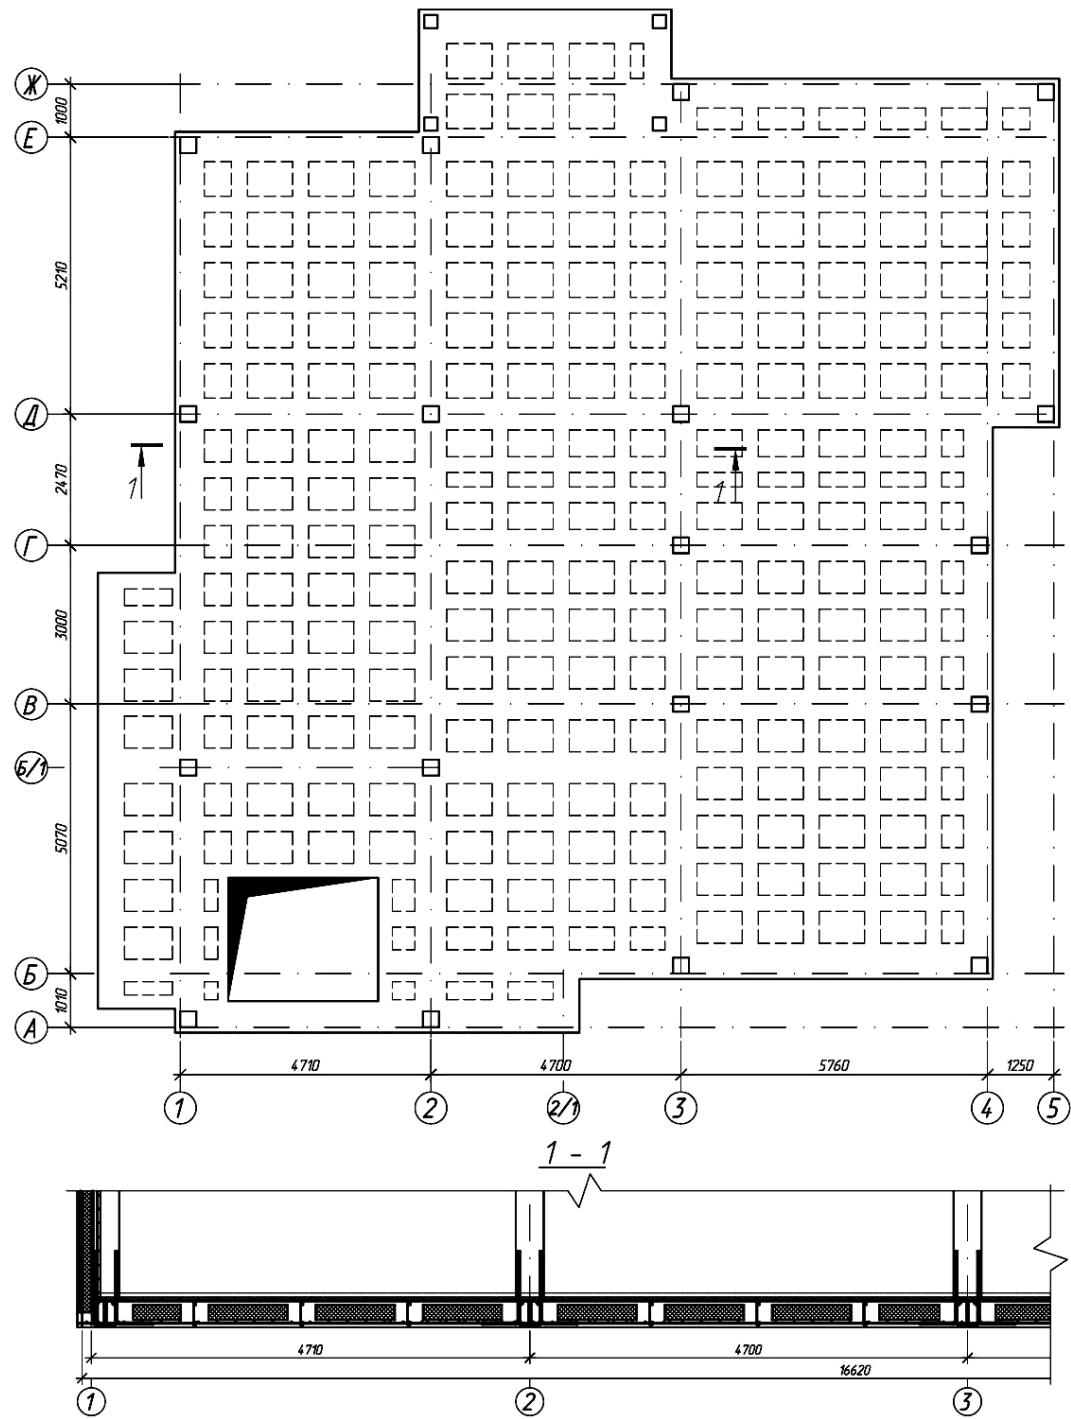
План і фрагмент перерізу фундаментної плити будівлі курортного готелю
